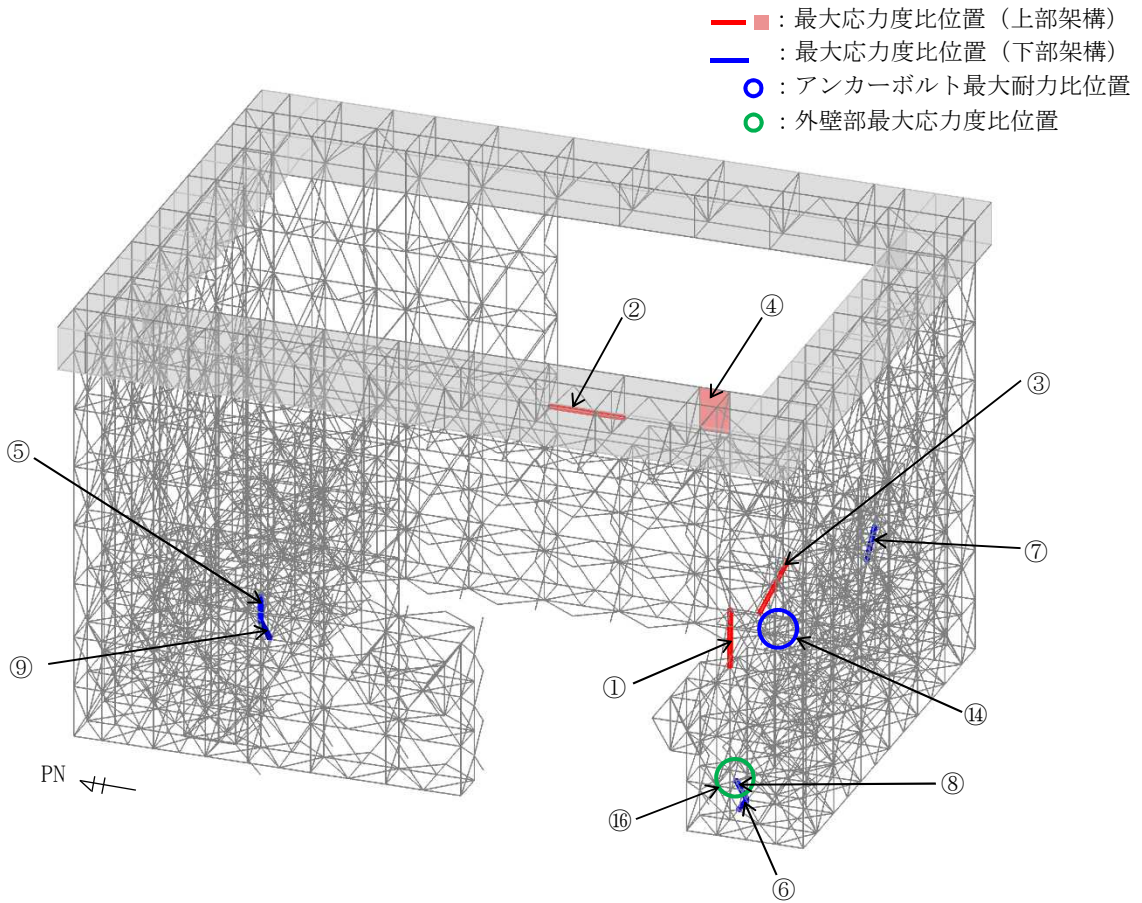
(1) 最大応力度比位置図(一般部, 常時)
